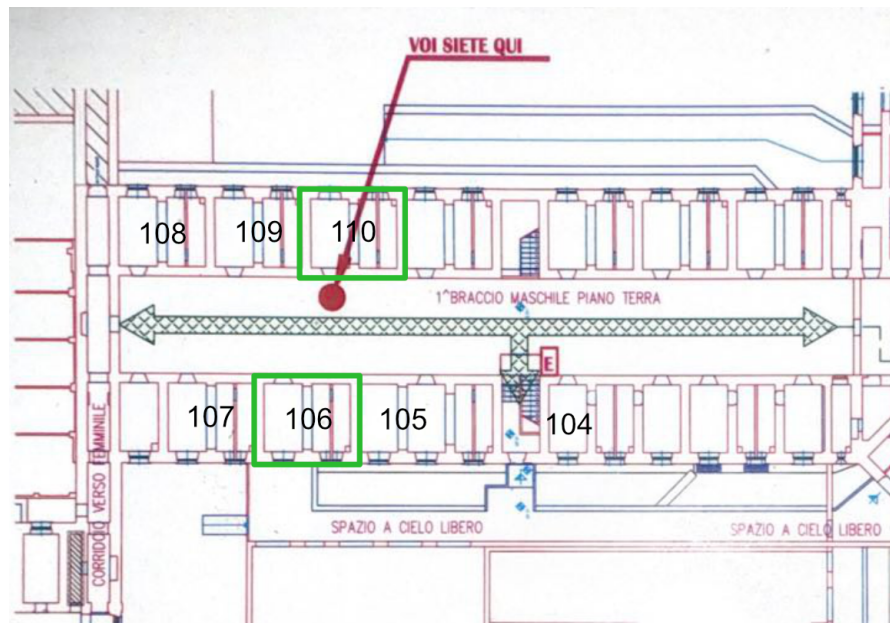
Pianta braccio maschile e disposizione celle illustrate nella Tabella 3.2
